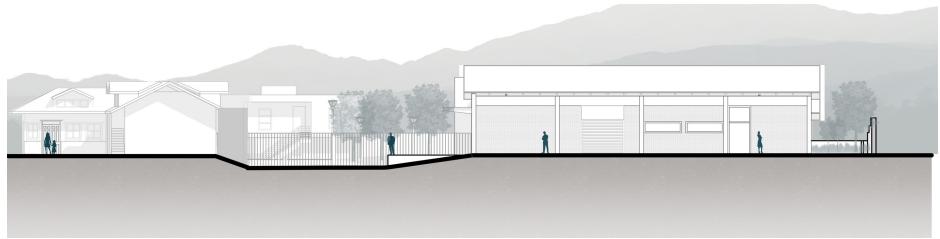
Elevación lateral derecha del proyecto. Fuente: Autores, 2024
